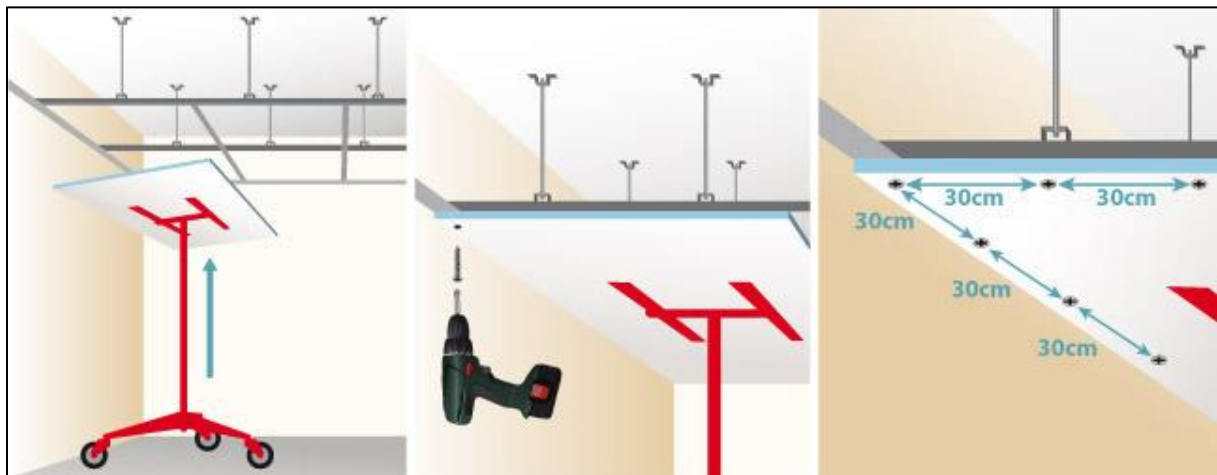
Installation des faux plafonds suspendus²¹⁴
